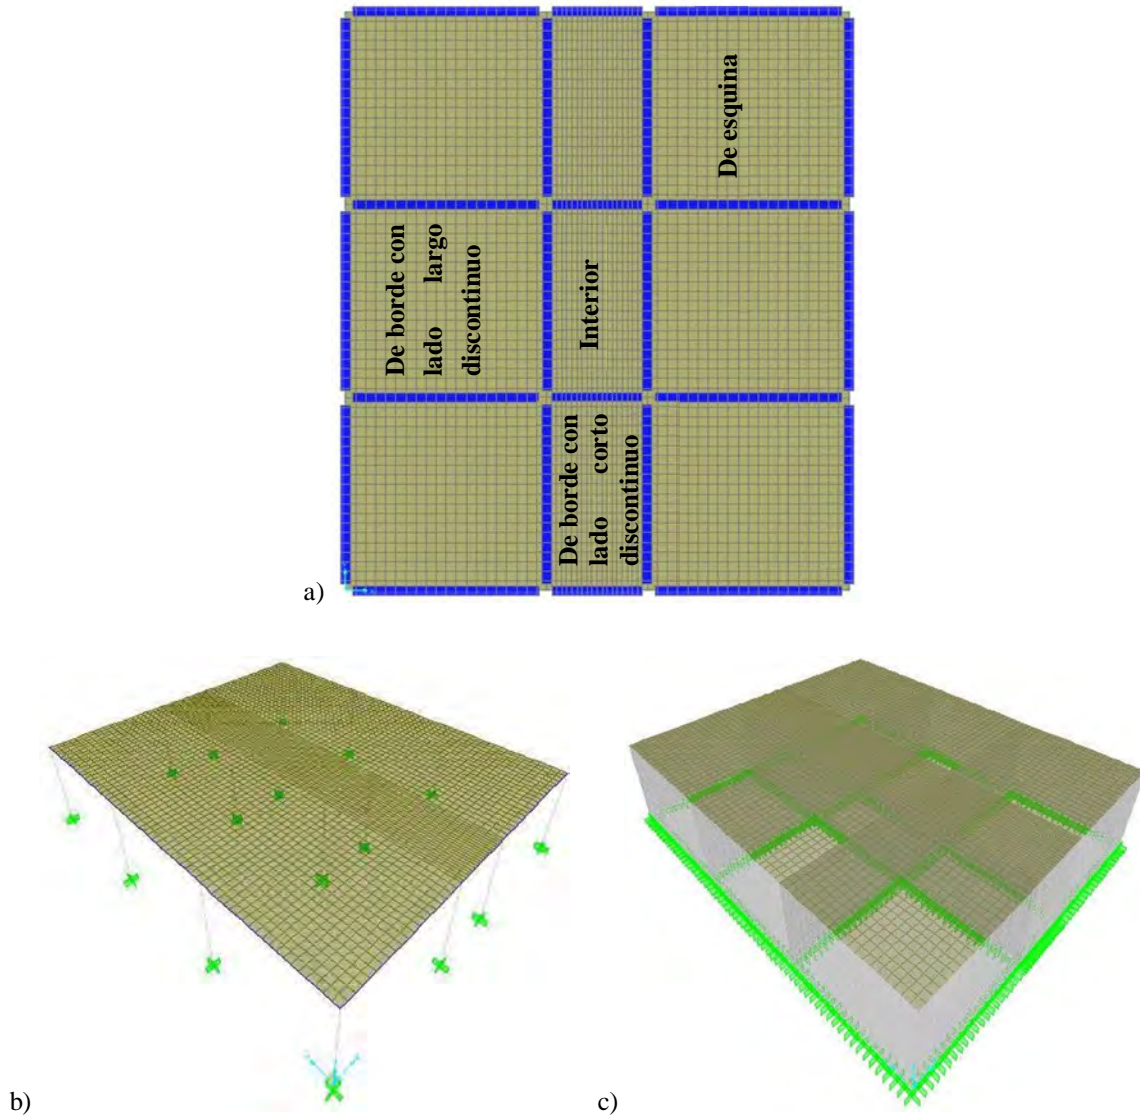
Modelo para tableros interiores y de borde con un lado corto discontinuo: a) planta, b) apoyados sobre vigas y c) sobre muros.
